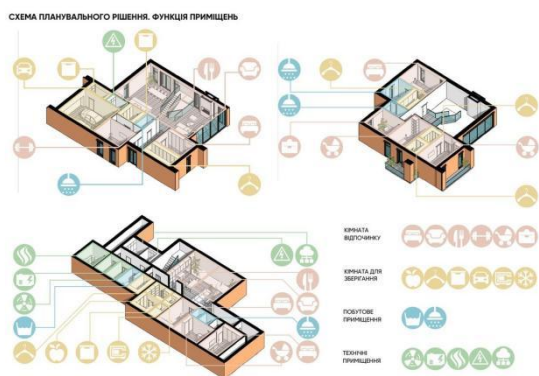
Схеми планувального рішення концептуального будинку.
